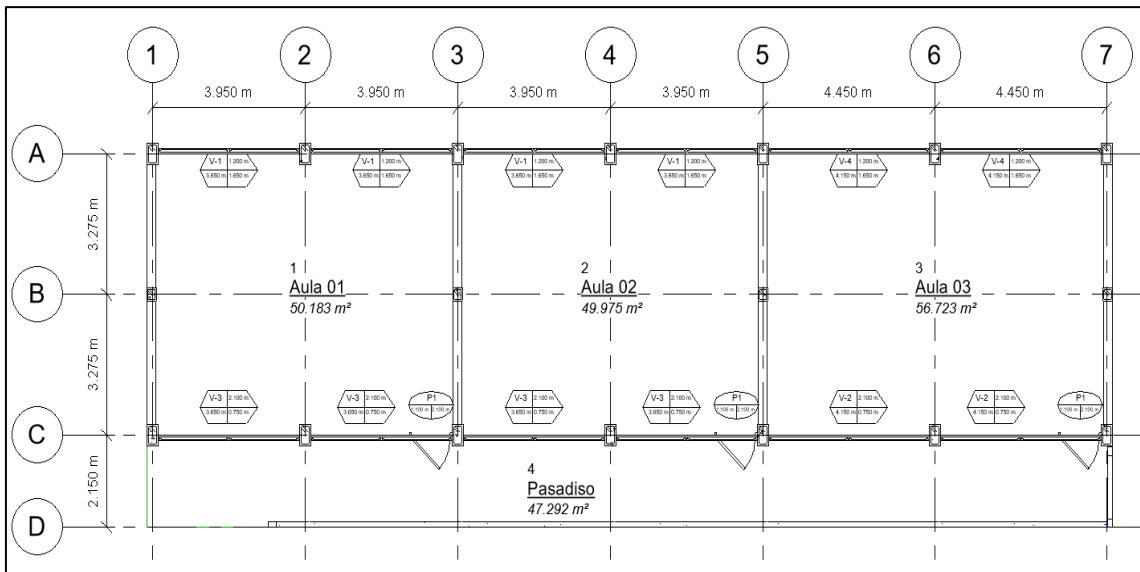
Planta baja del Módulo A de la I.E. N° 20123
